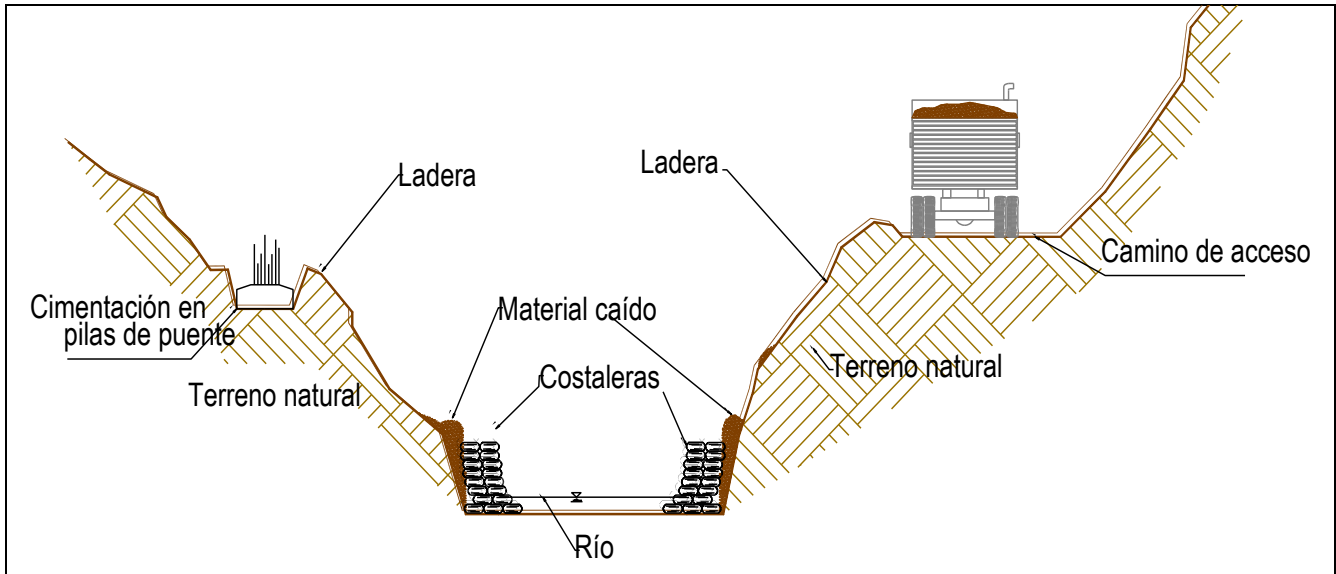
Ejemplo de colocación de gaviones instalados en las márgenes de un río.
